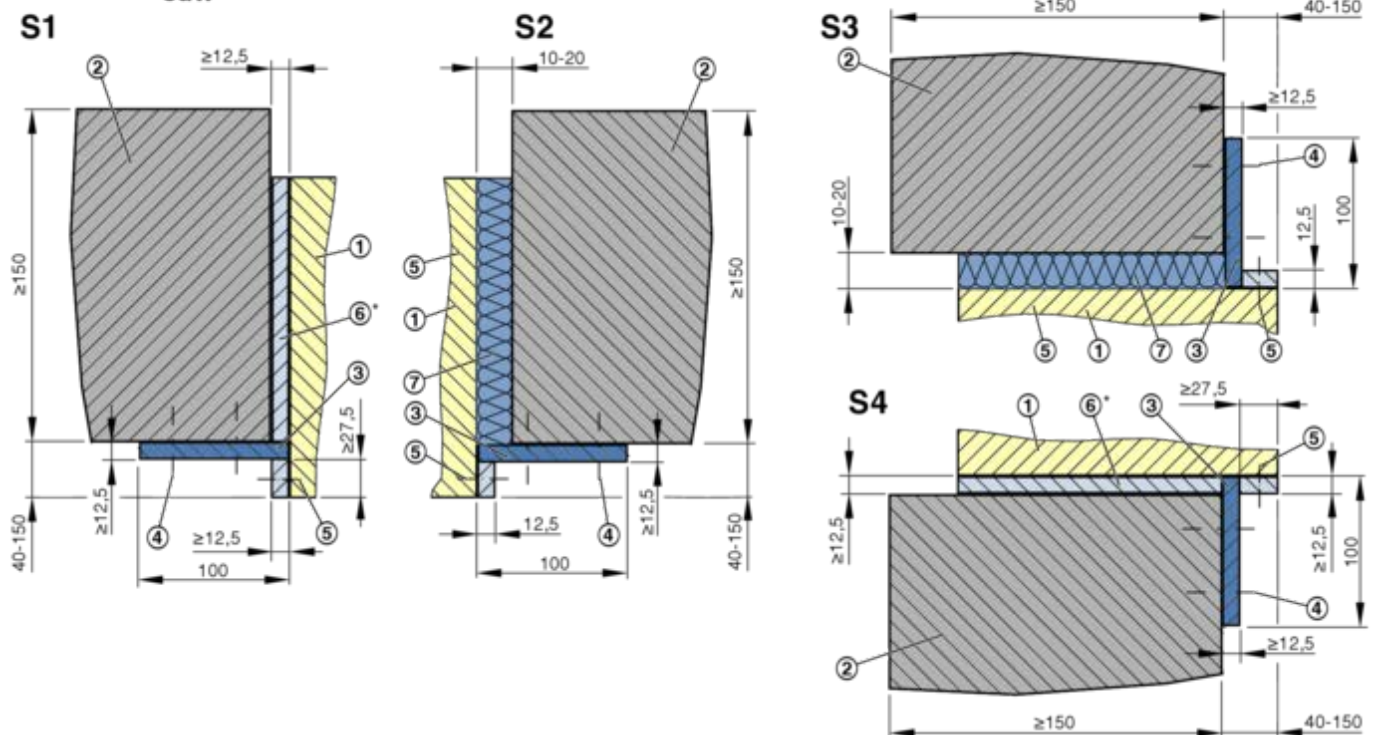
Dettagli installazione a secco senza malta EK-JZ in una parete piena, parete piena con intercapedine EI 90 S
